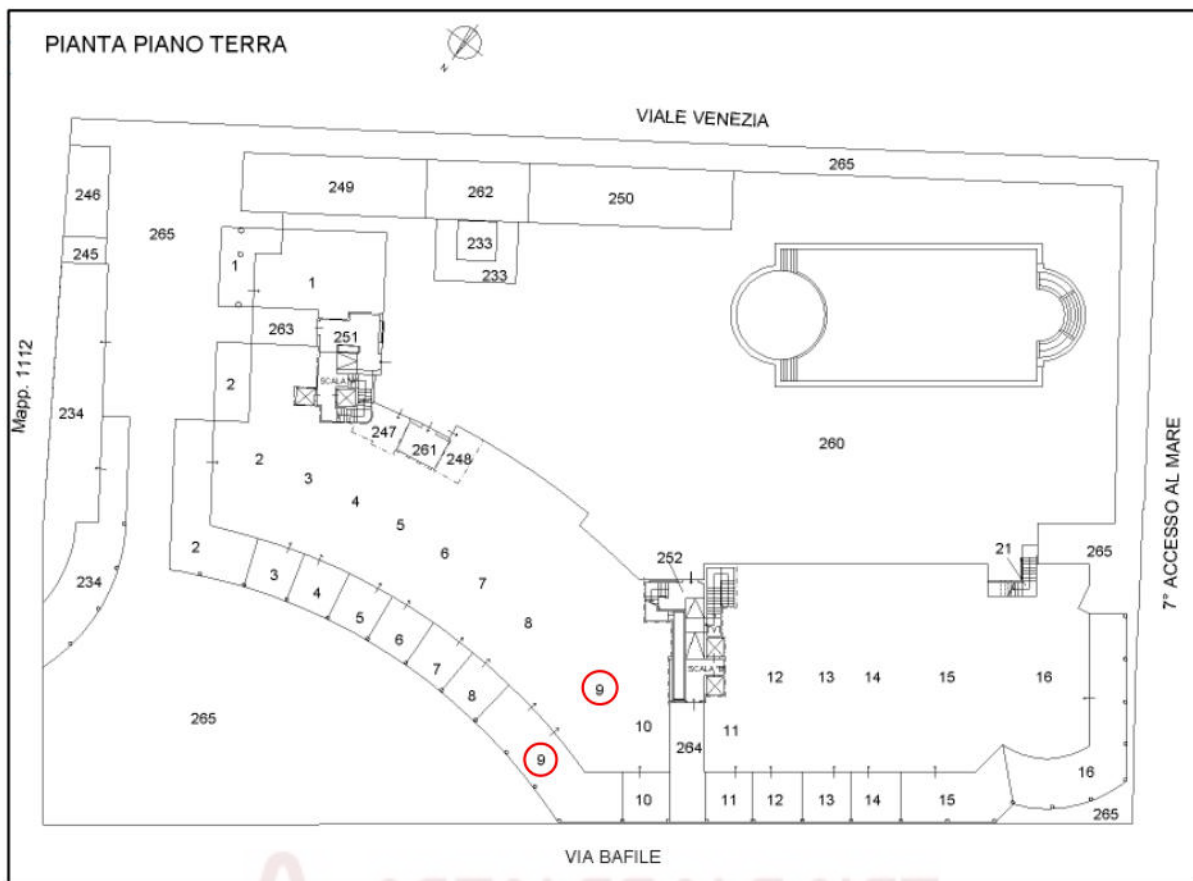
Estratto dell'elaborato planimetrico (Catasto Fabbricati)
